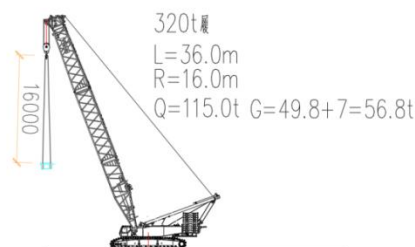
P109-110 双 T 梁履带吊吊装工况立面图
